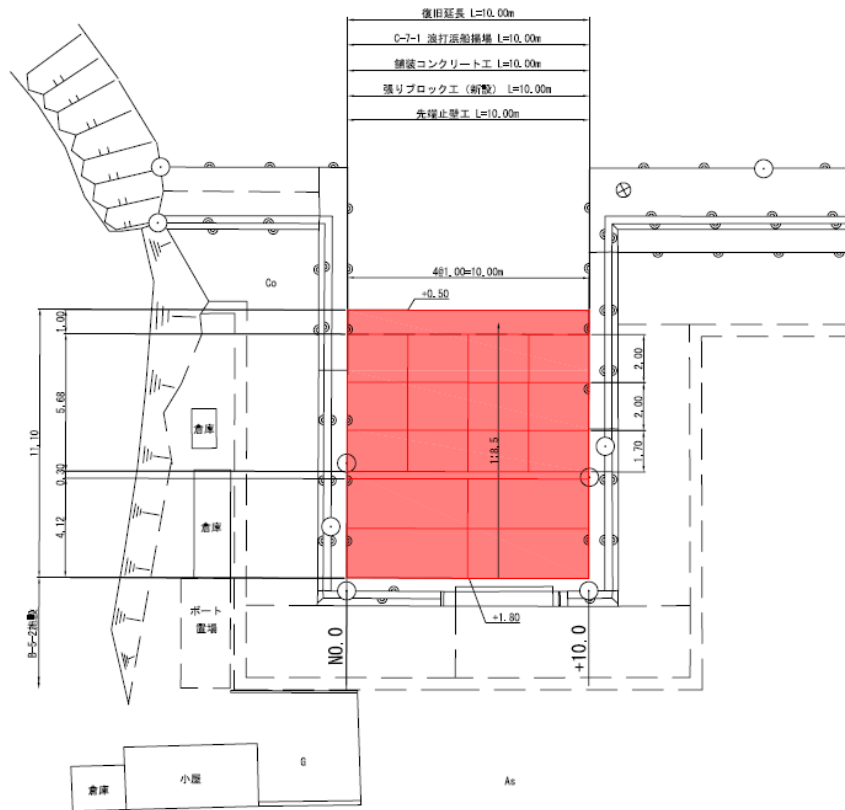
33 No.6 浪打浜船揚場の平面図（復旧後）
